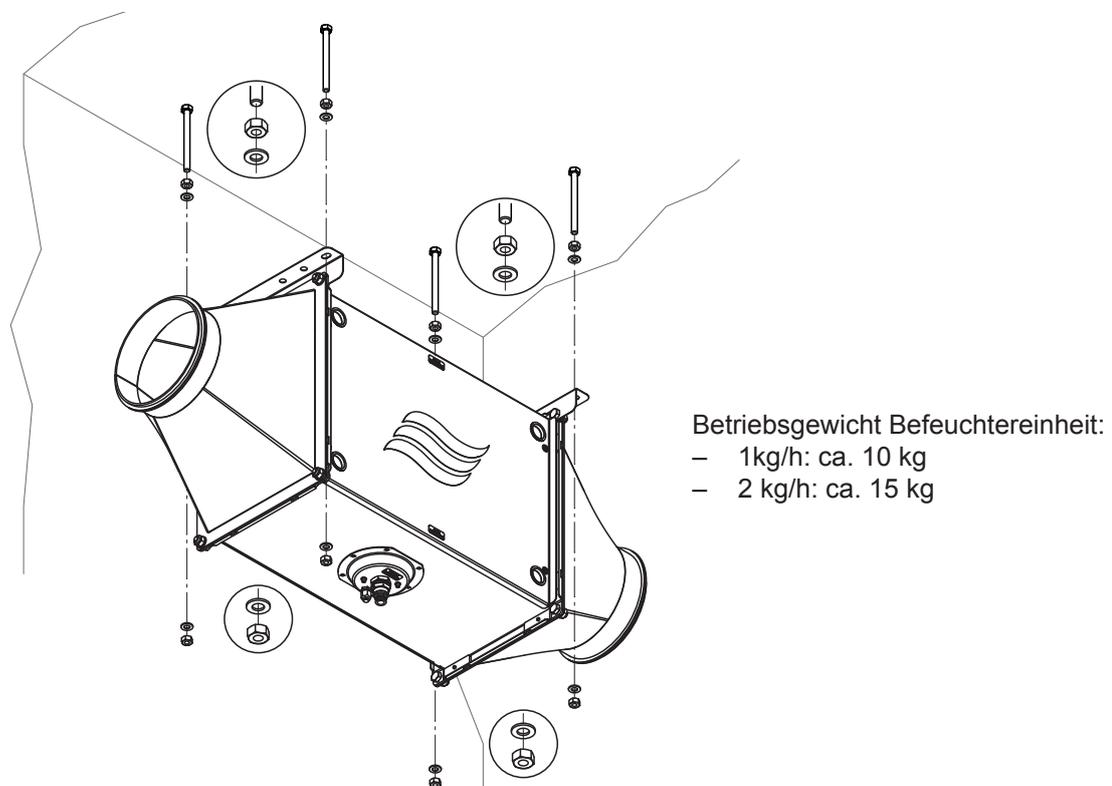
Befeuchtergehäuse an den Gewindestangen befestigen
